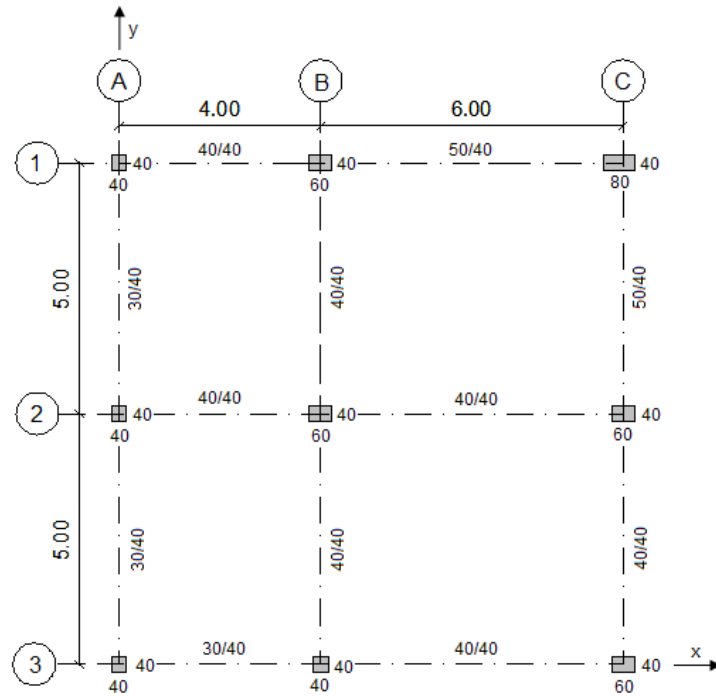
Distribución en planta del edificio sin considerar mampostería
